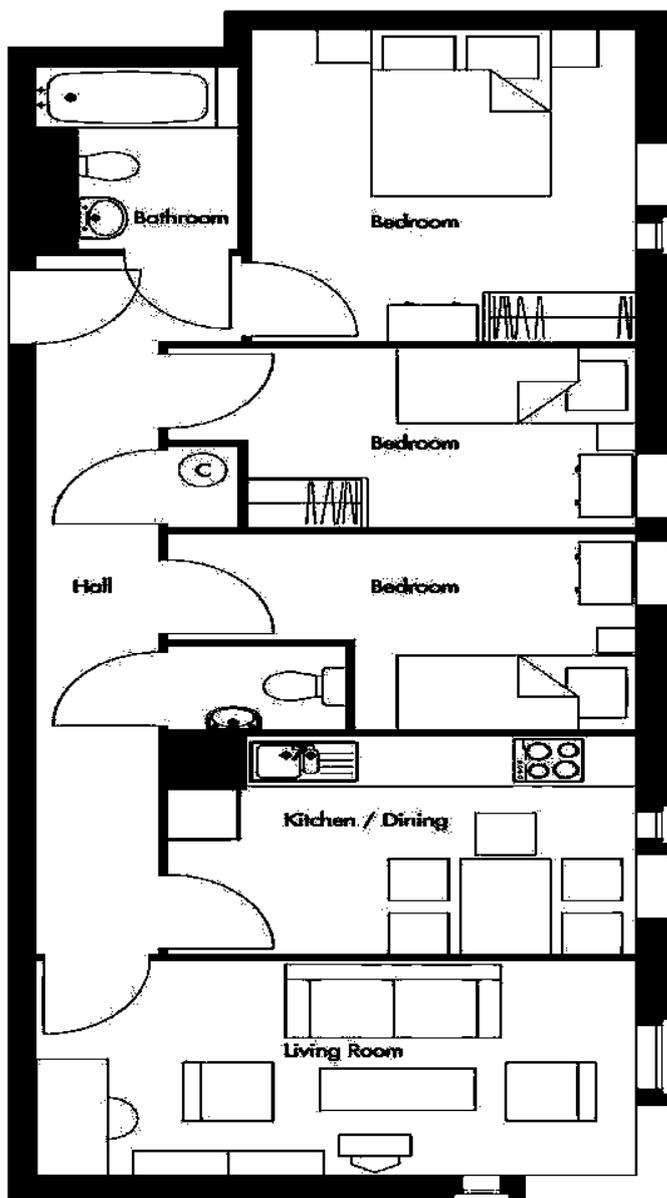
West Cambridge Site. Planta de departamento de tres habitaciones
